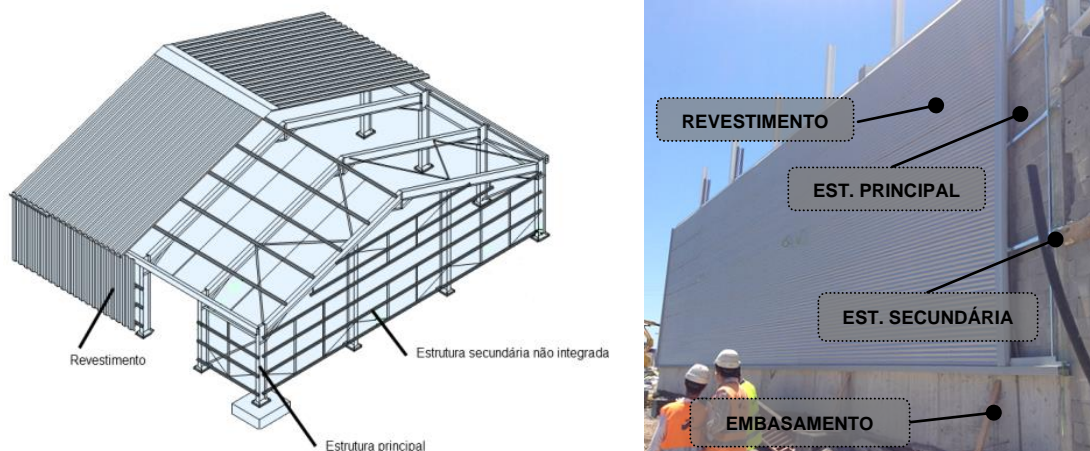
Sistema construtivo de fachada em chapa metálica: a. Ilustração genérica (adaptado de SCI, Single-Storey Steel Buildings: Building Envelope); b. Fase de construção
